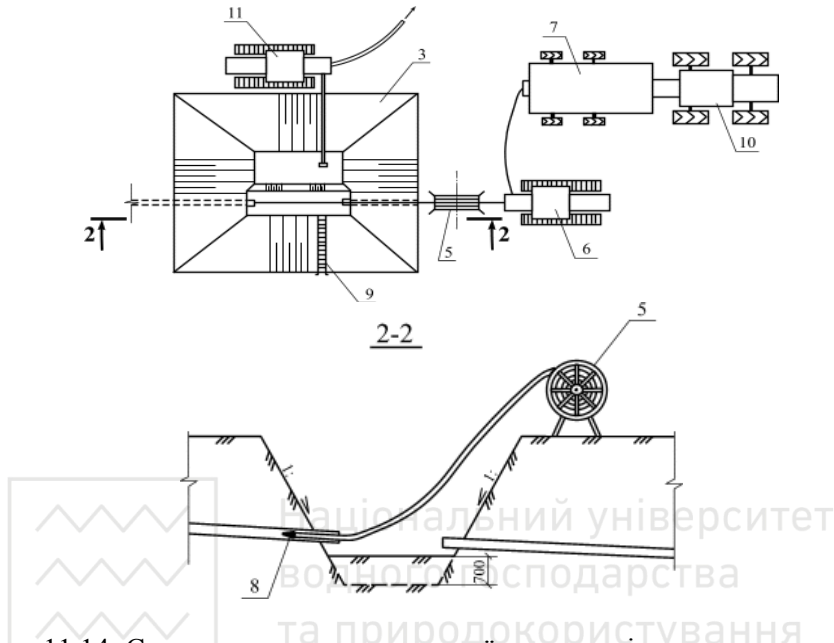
Схема промивання середньої частини ділянки колектора через технологічний шурф. 3 – технологічний шурф; 5 – барабан з напірним шлангом; 6 - трактор ДТ-75 з насосом ЦНС 38-176; 7 - цистерна з водою; 8 - промивна головка; 9 – драбина; 10 – трактор К-700; 11 - трактор ДТ-75 з насосом С-245
